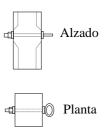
Disposición de elementos fijos en apoyos de hormigón
